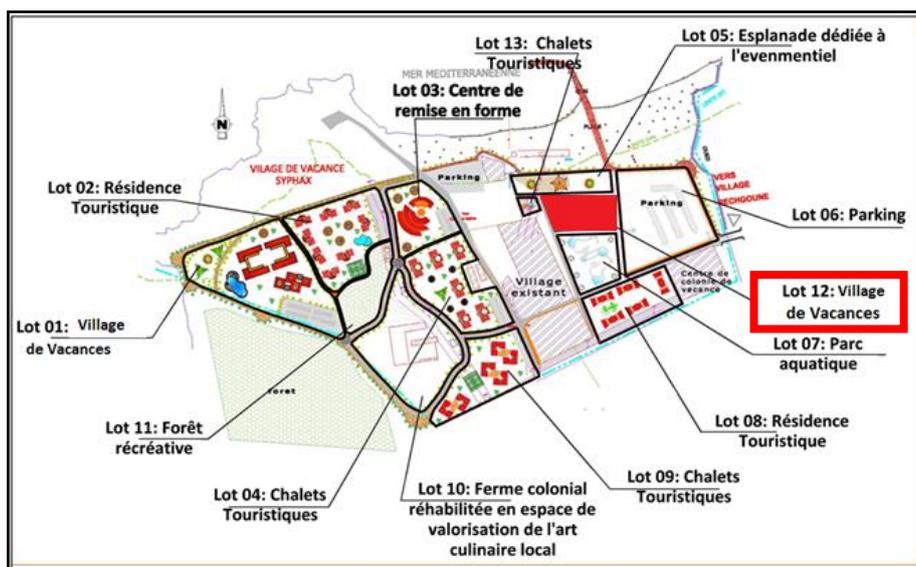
Plan d'aménagement touristique de la zet de rachgoun
